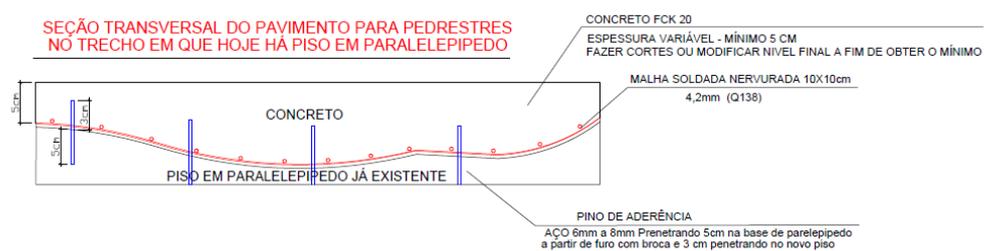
Detalhe transversal da constituição do pavimento sobre o trecho de paralelepípedo pré-existente.
